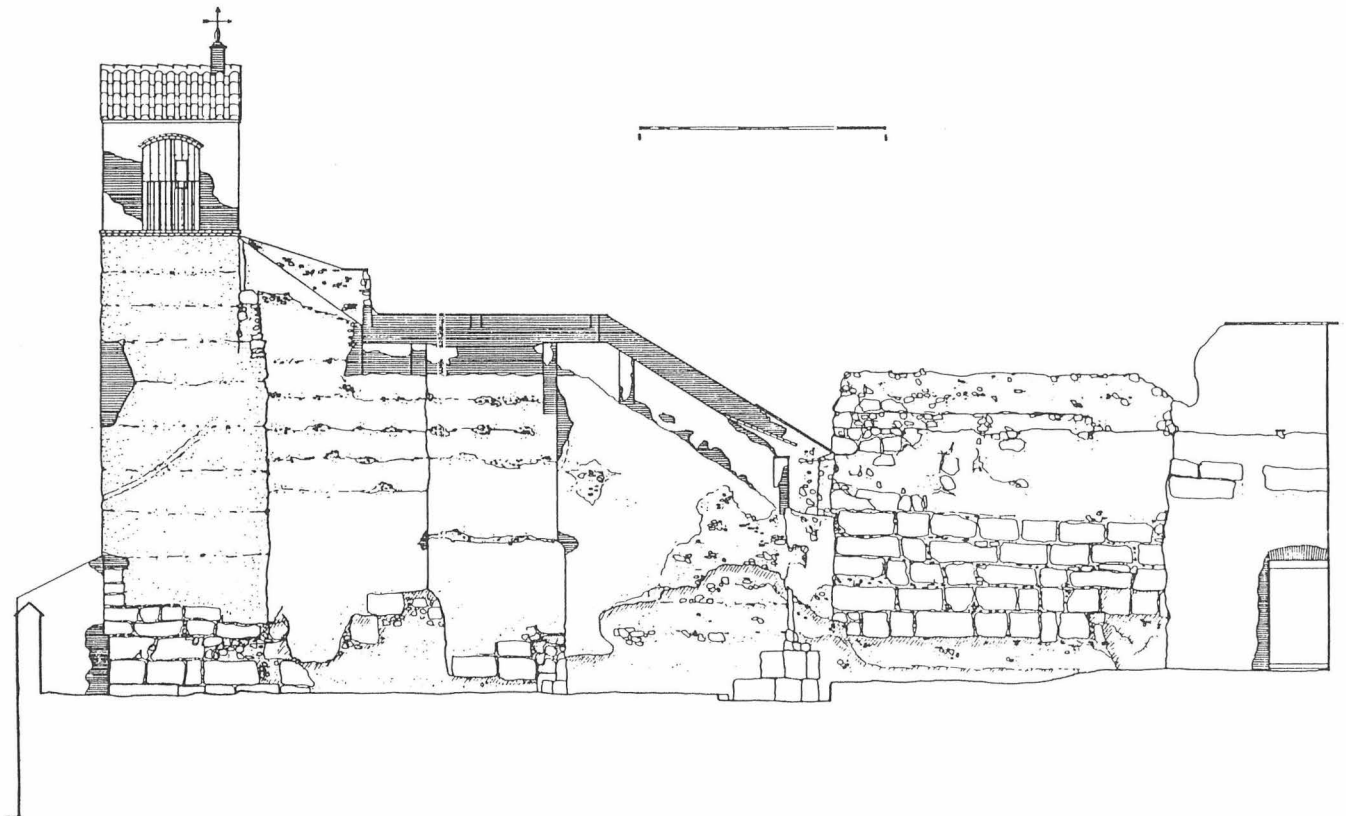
Alzado exterior de la torre y sección interna del solar.
